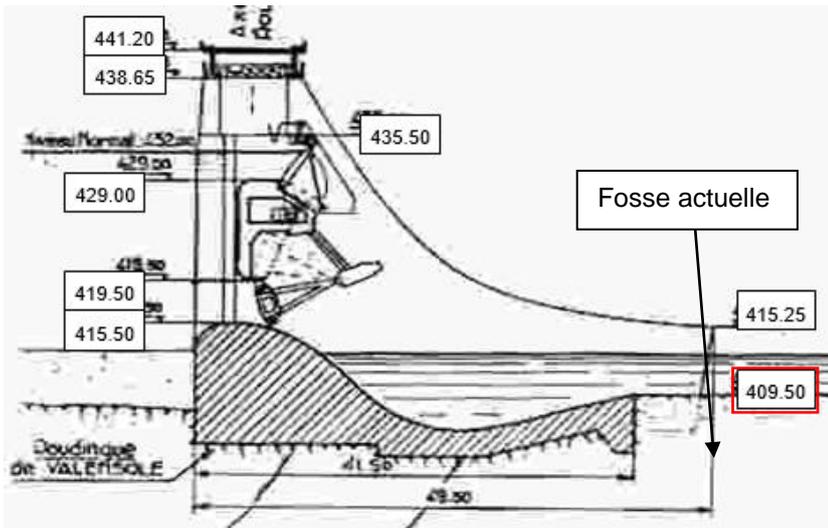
Coupe au droit des vannes du barrage de l'Escale (à la construction). Cotes en NGFO
